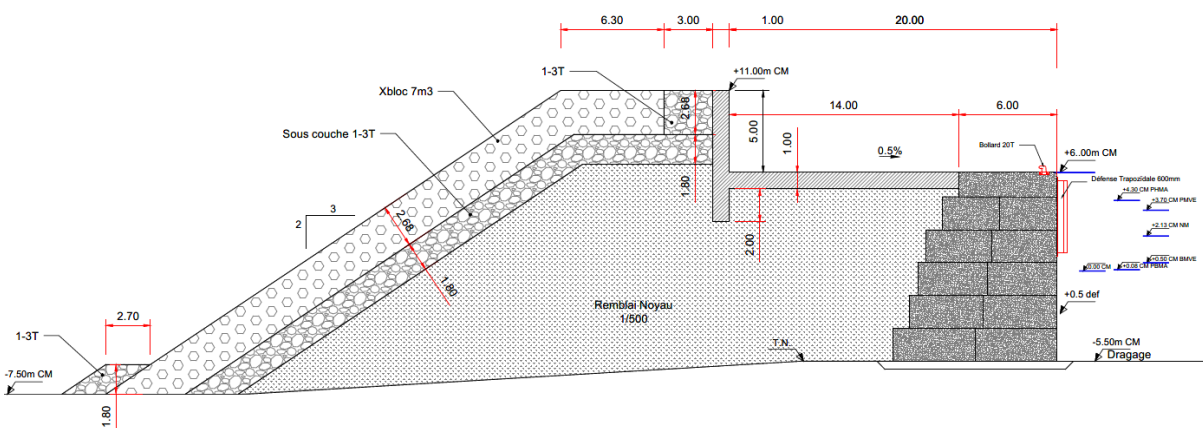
Coupe en travers brise lame au droit du quai à marchandises
